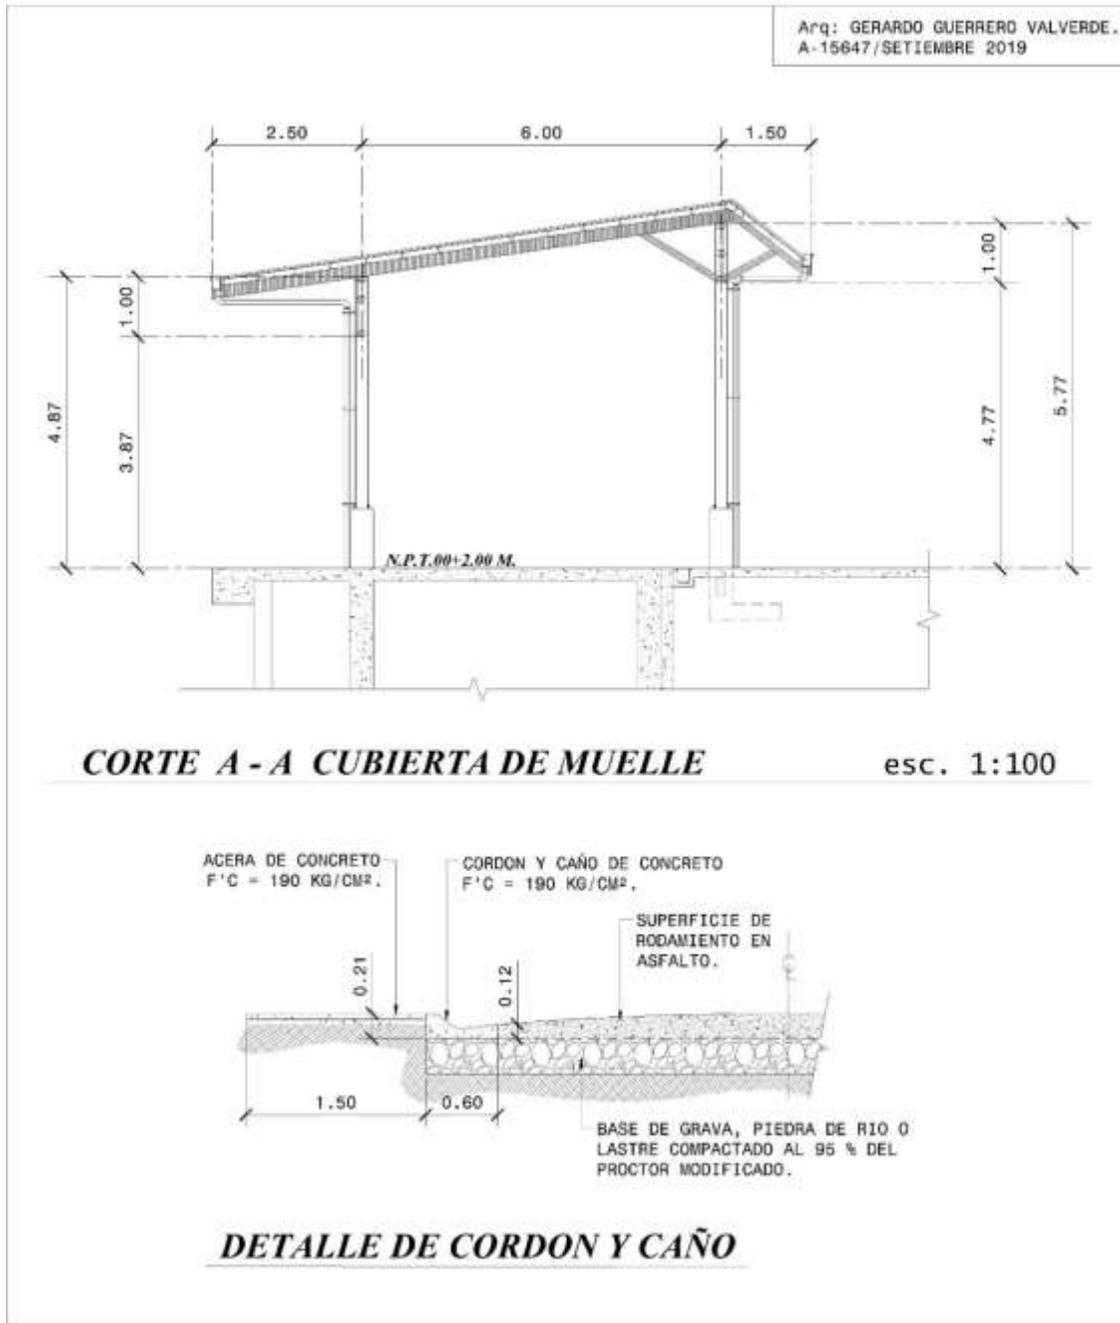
Plano de cubierta de muelle y detalle de cordón y caño
